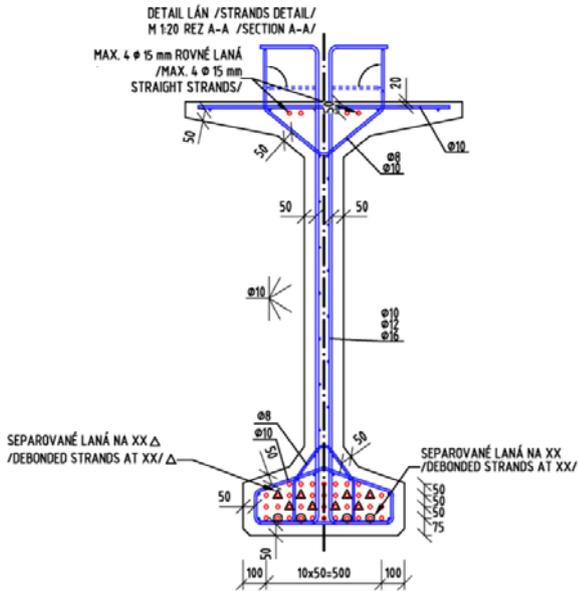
Sección tipo de las vigas desarrolladas para D4R7.
